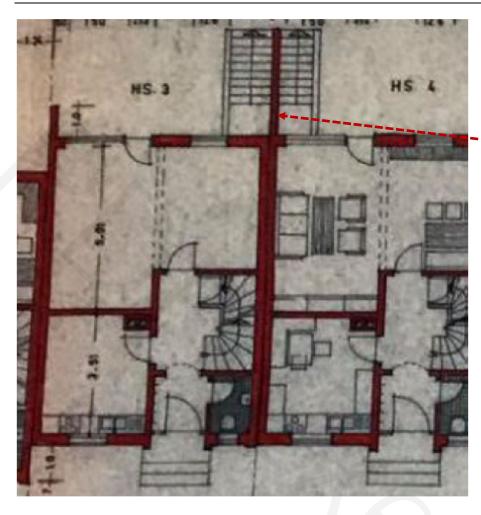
Auszug aus der Eingabeplanung, Grundrissplan EG:
